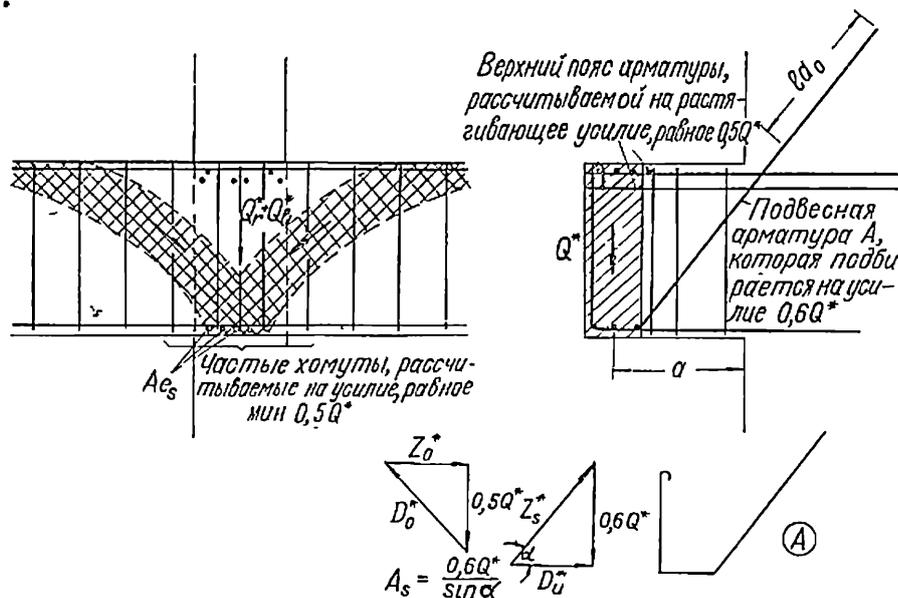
5. Армирование консольного примыкания балки к колонне
